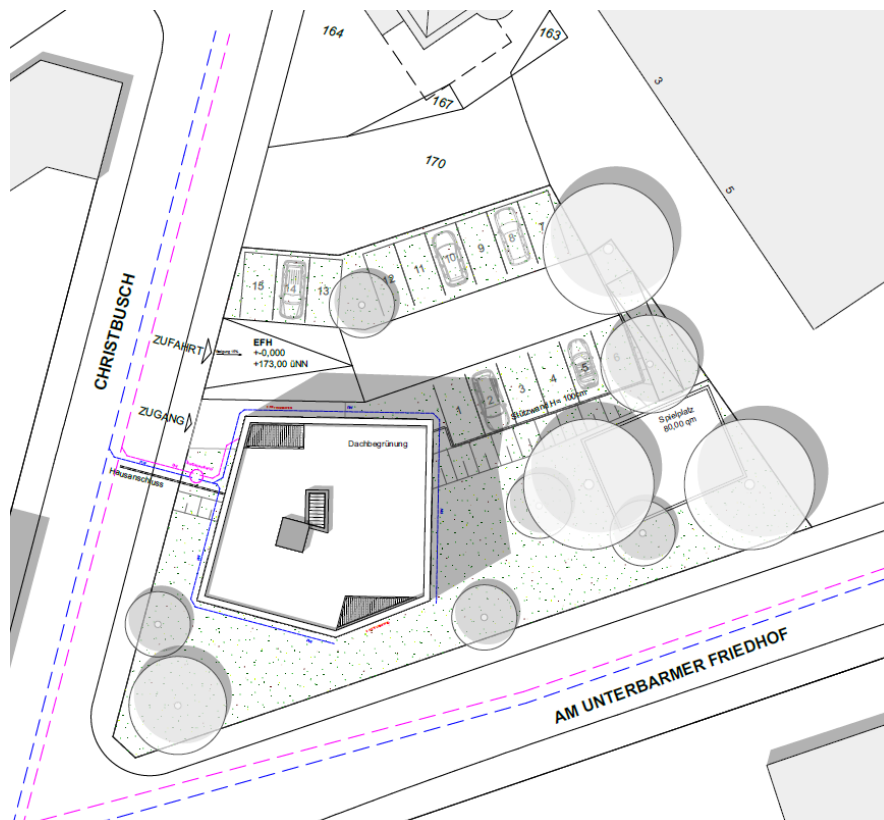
Ansicht und Lageplan Mehrfamilienhaus
